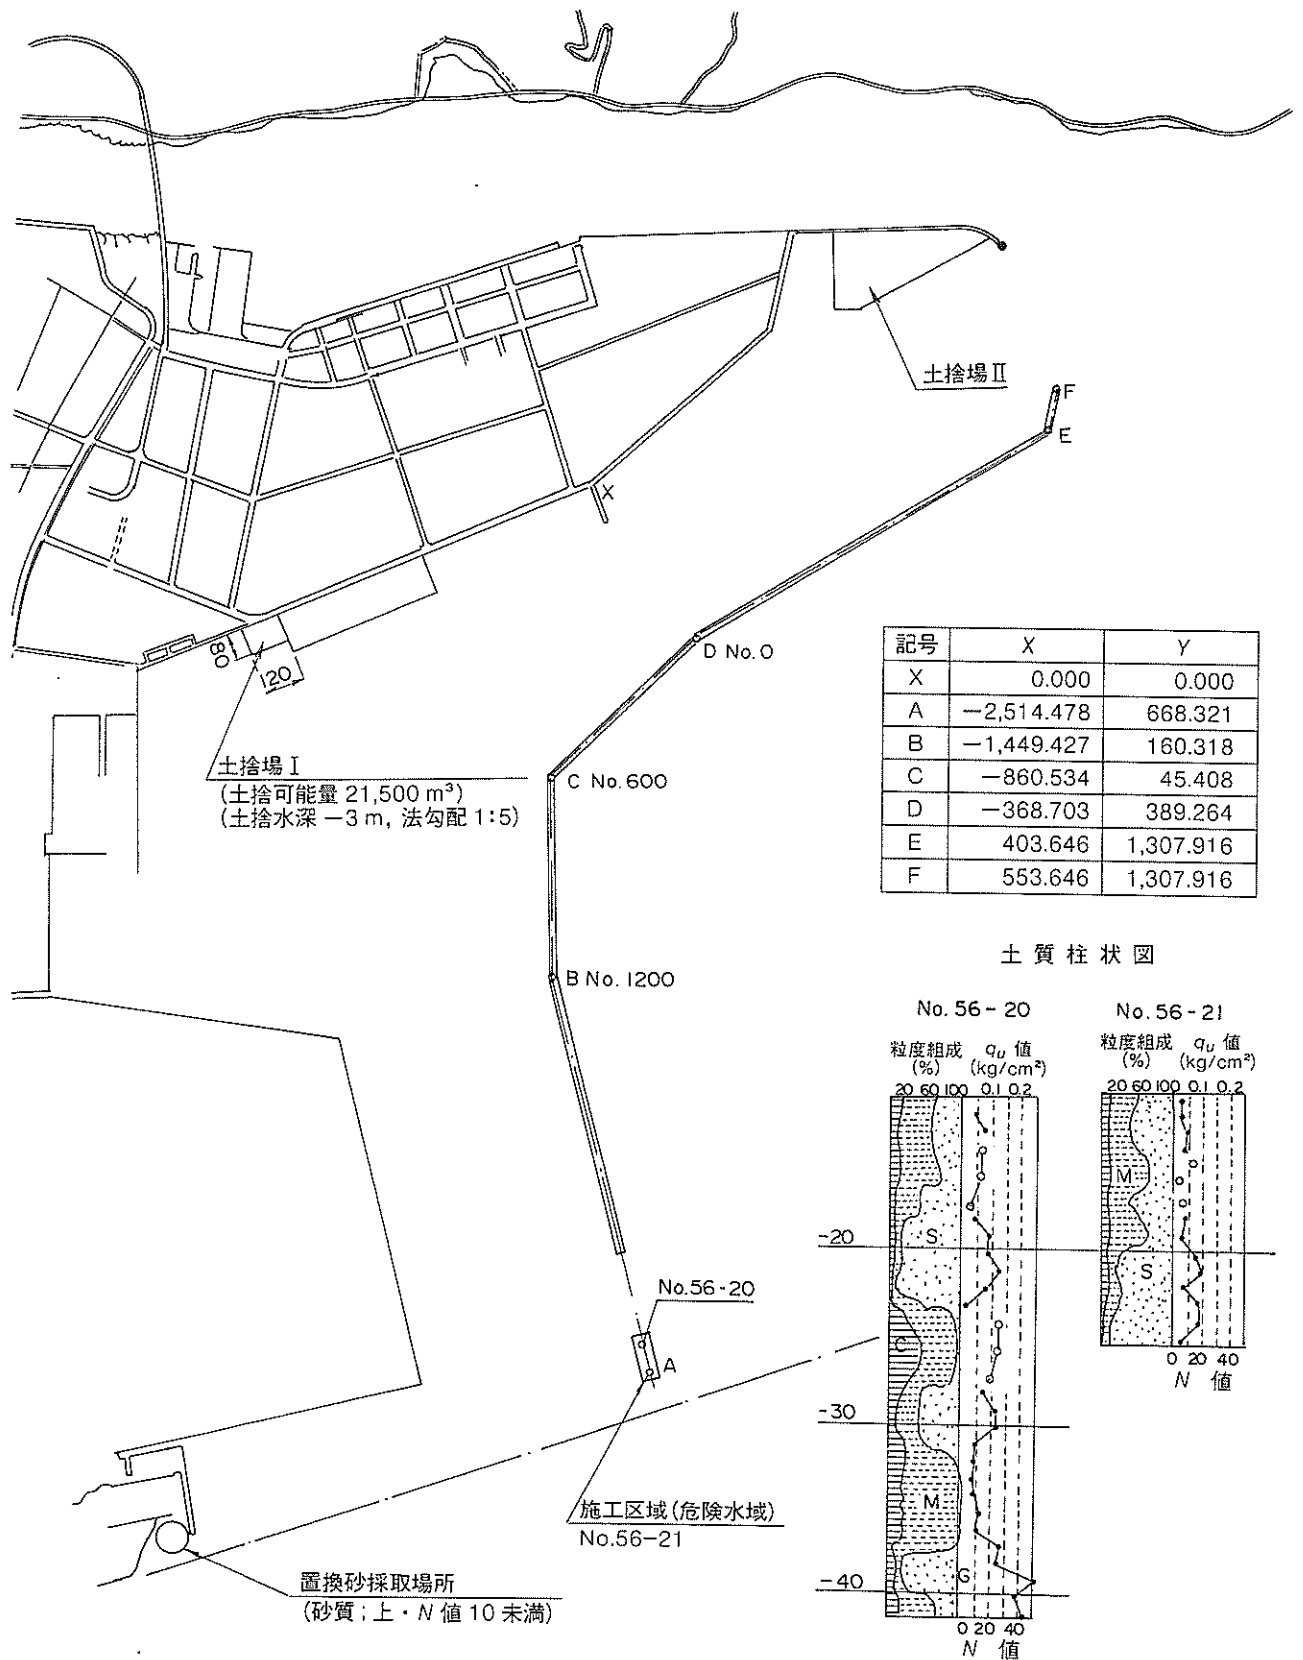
沖防波堤南端部(二重円筒ケーソン)(22) 平面位置・土質柱状図
